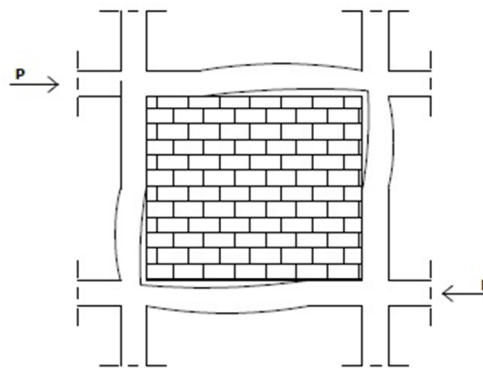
Separação entre o pórtico e a alvenaria [1]
